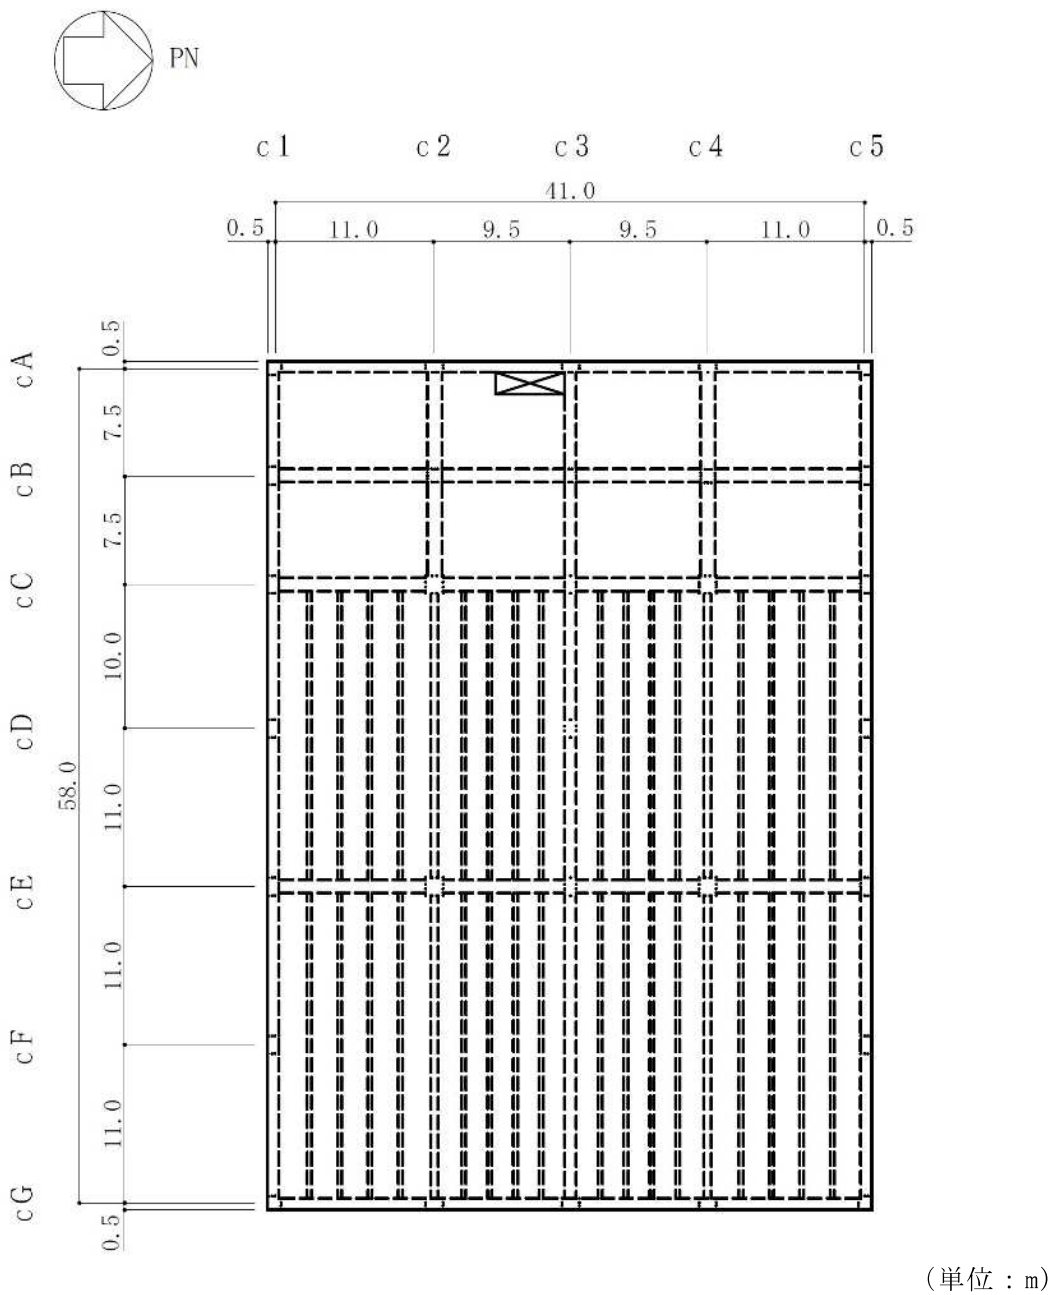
コントロール建屋の概略平面図 (RF, T. M. S. L. 24. 1m) (5/5)
